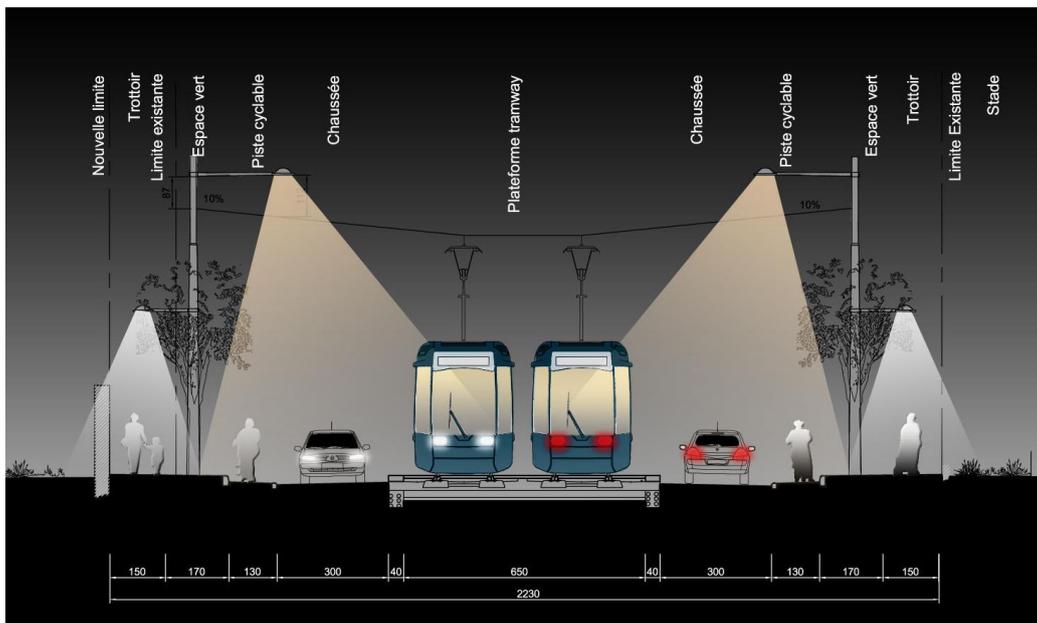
Exemple d'éclairage de la plateforme axiale voie double, voirie, pistes cyclables, piétons et plantations
